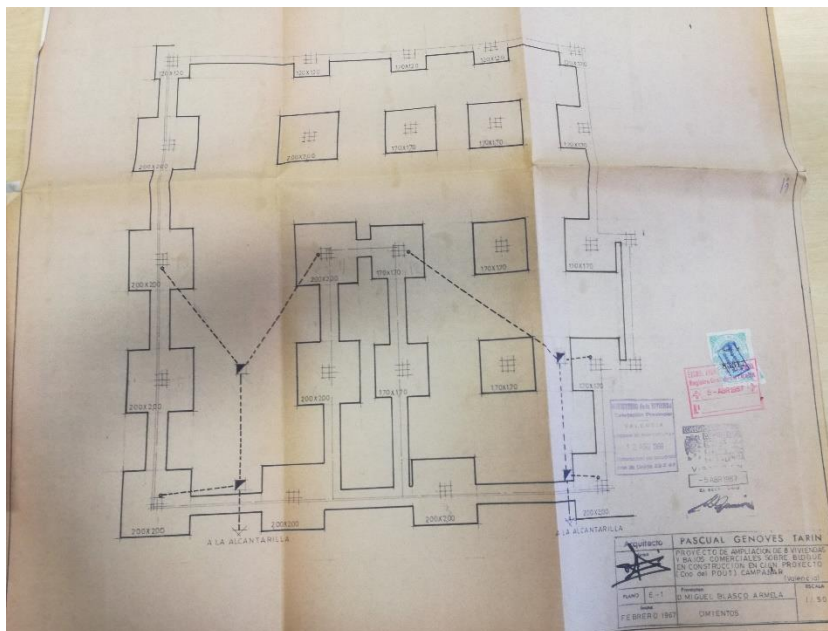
Planta cimentaciones Riola 1. Archivo Histórico Municipal
